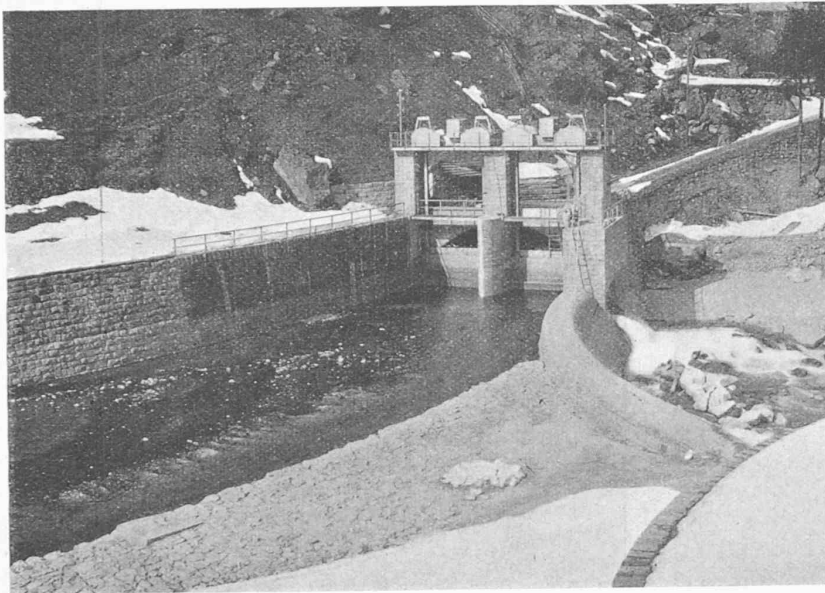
Einlauf des Umlauf-Tunnels, rechts das Leitwehr.
